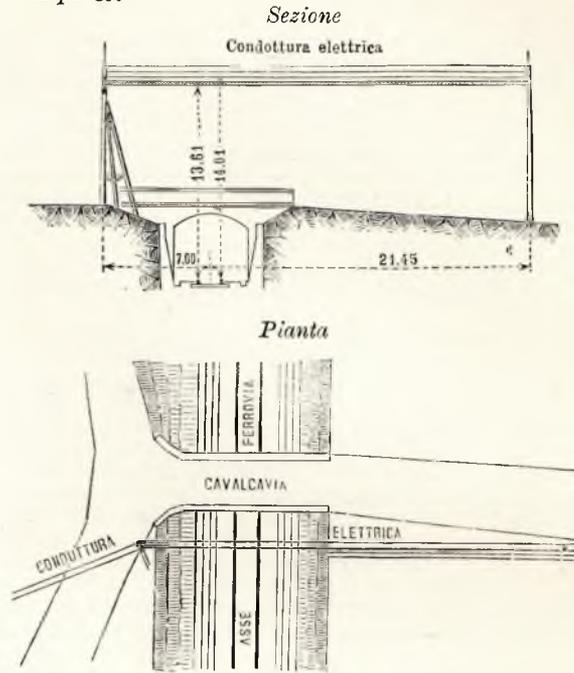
Attraversamento con condotta elettrica sospesa in corrispondenza ad un cavalcavia.
